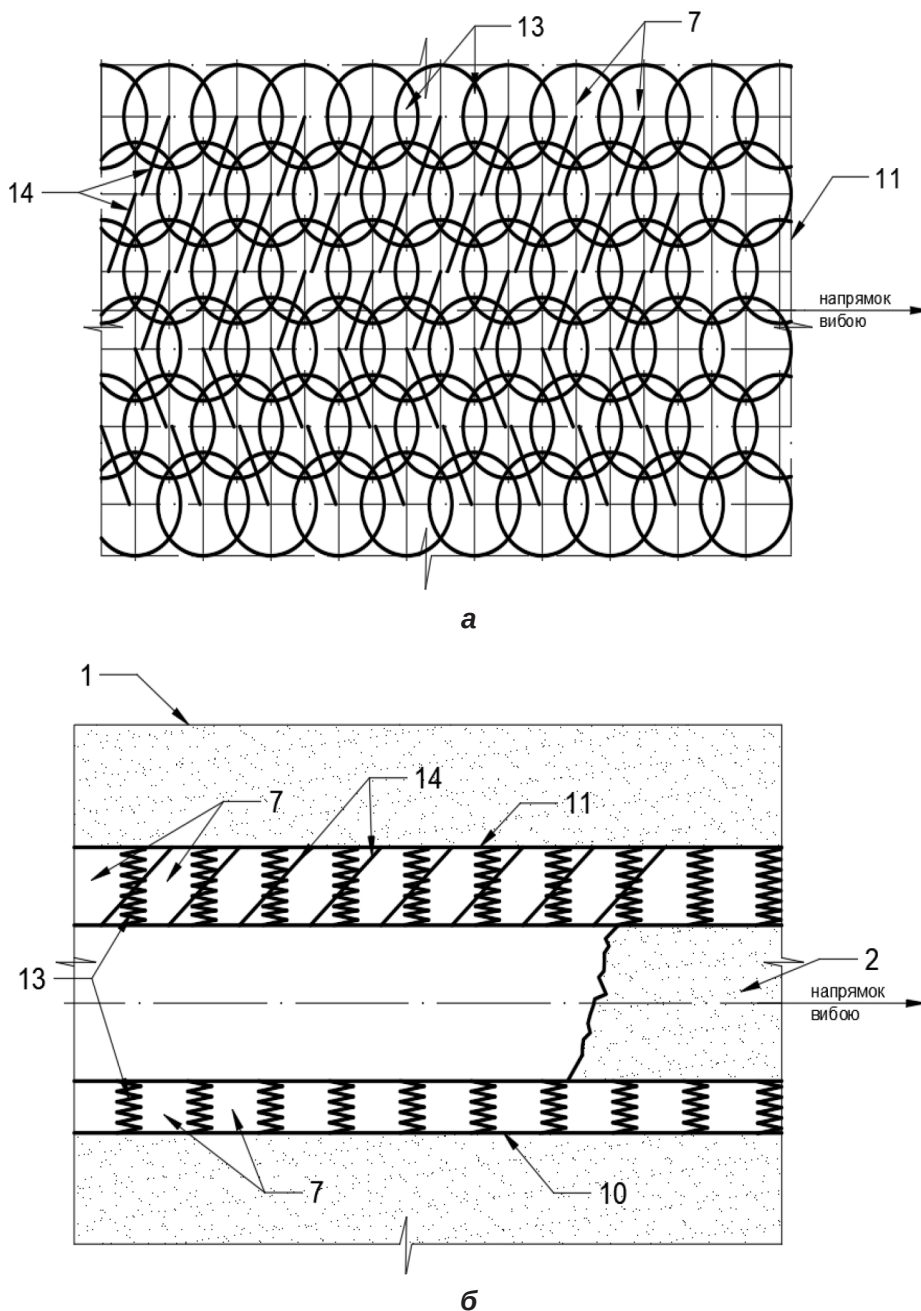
Схема анкерування (армування) ґрунтобетонного перекриття:
